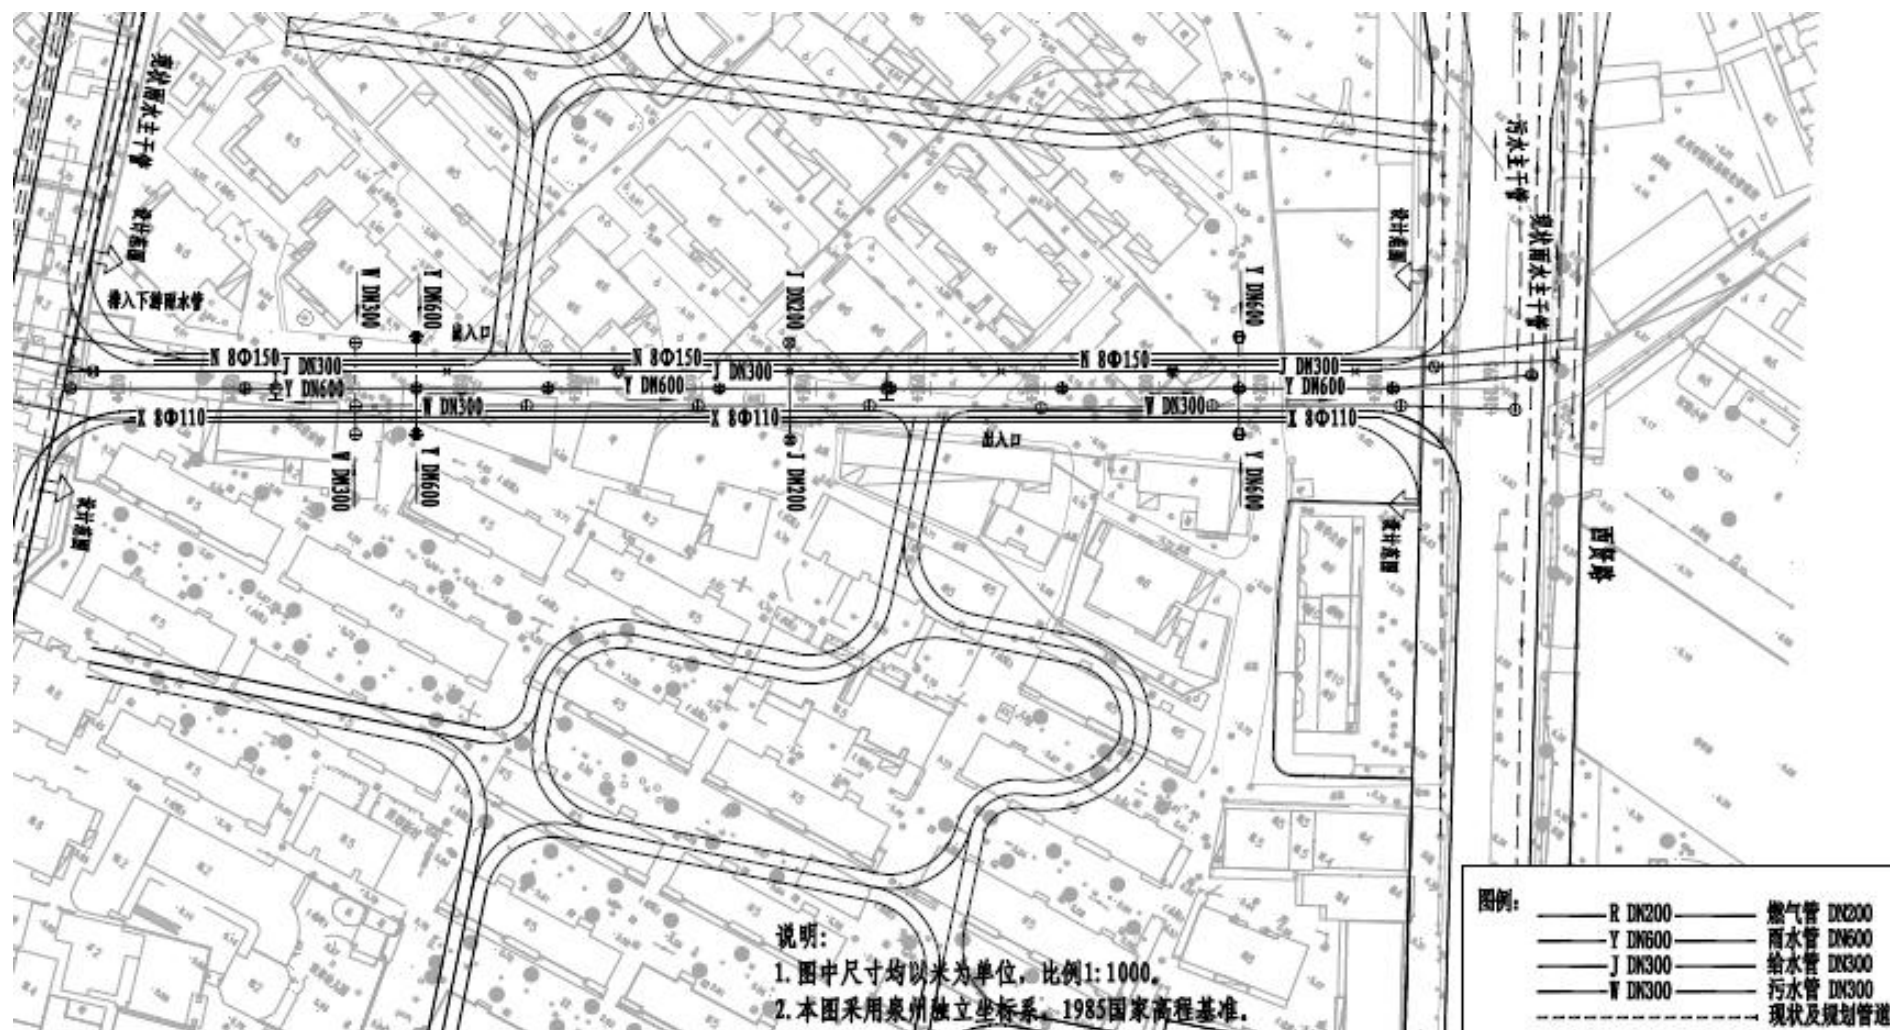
项目道路管线平面布置图 (含燃气管、雨水管、给水管、污水管)
